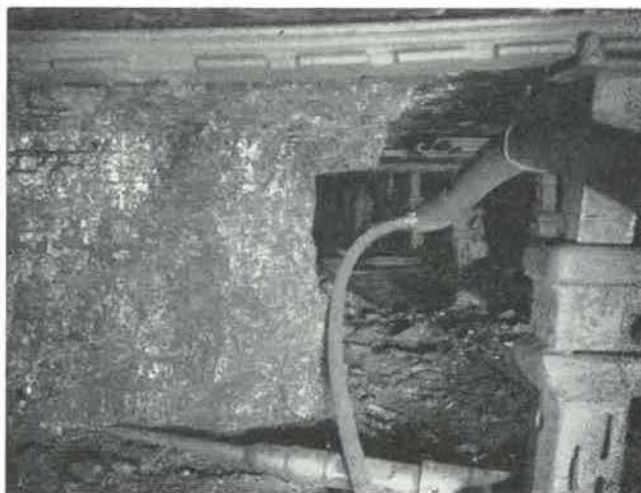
Conduite flexible avancée dans la nouvelle allée avant placement de l'étauçon.
